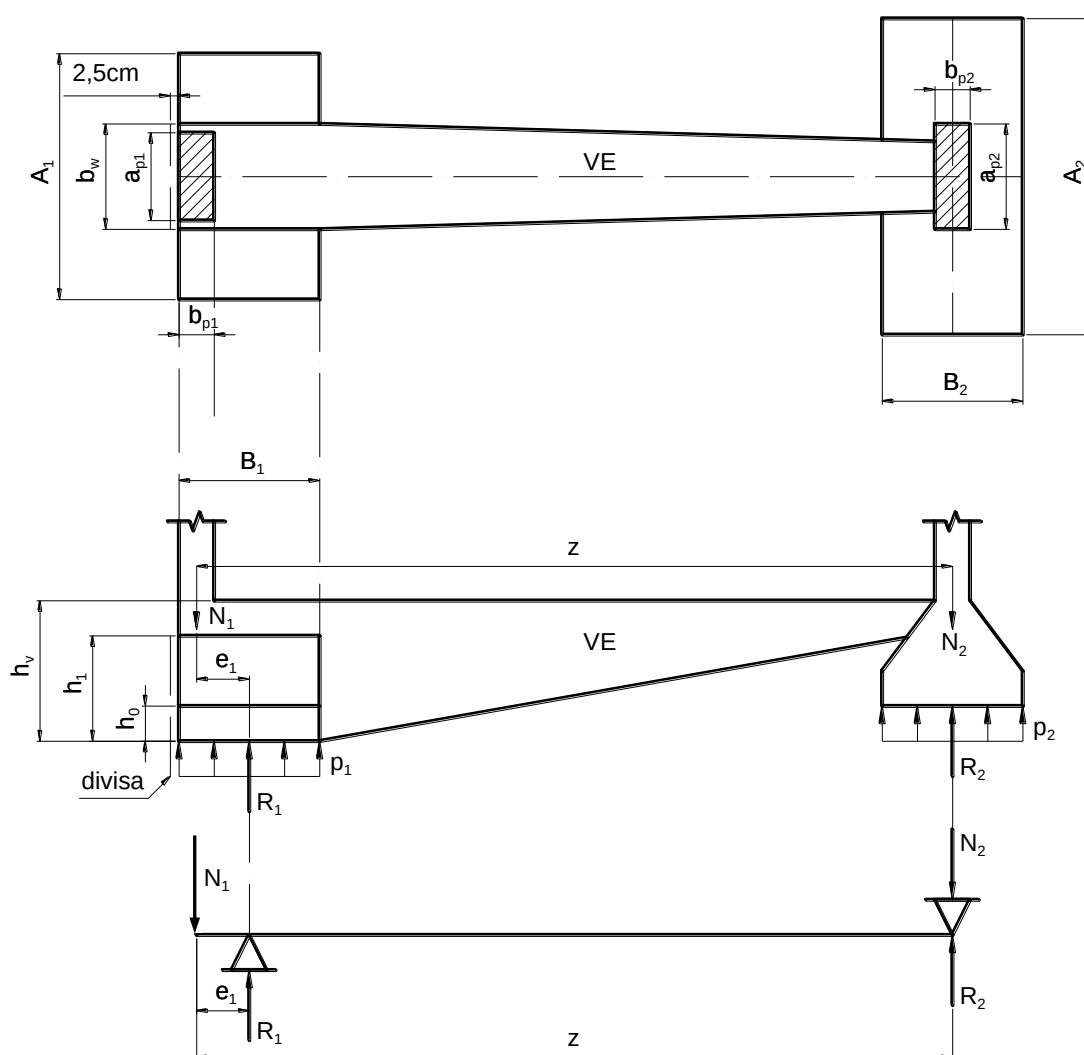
Notações da sapata com viga de equilíbrio.
